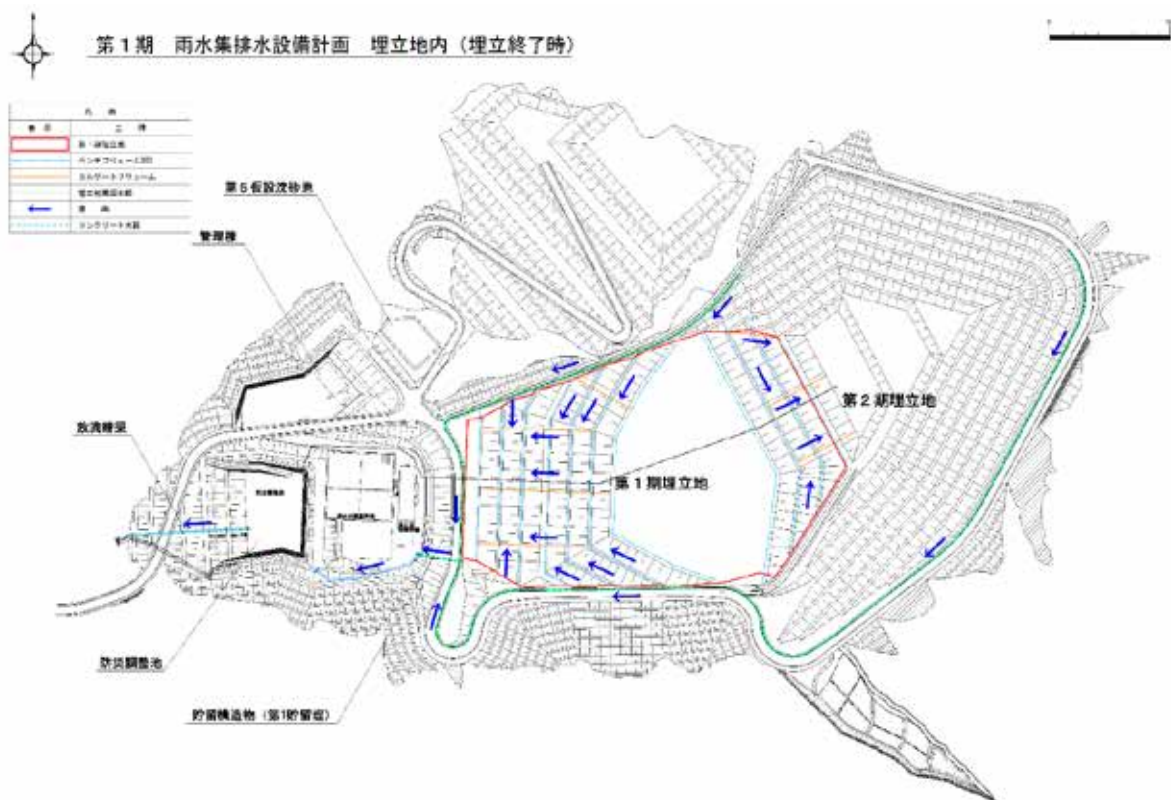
雨水集排水設備配置図 第1期埋立終了時
